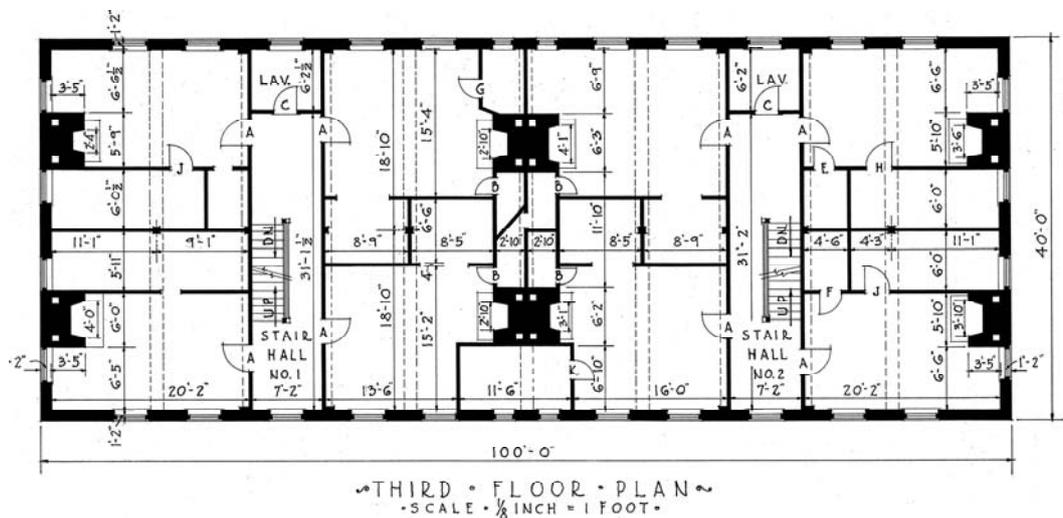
Connecticut Hall, Yale Universität, Grundriss
